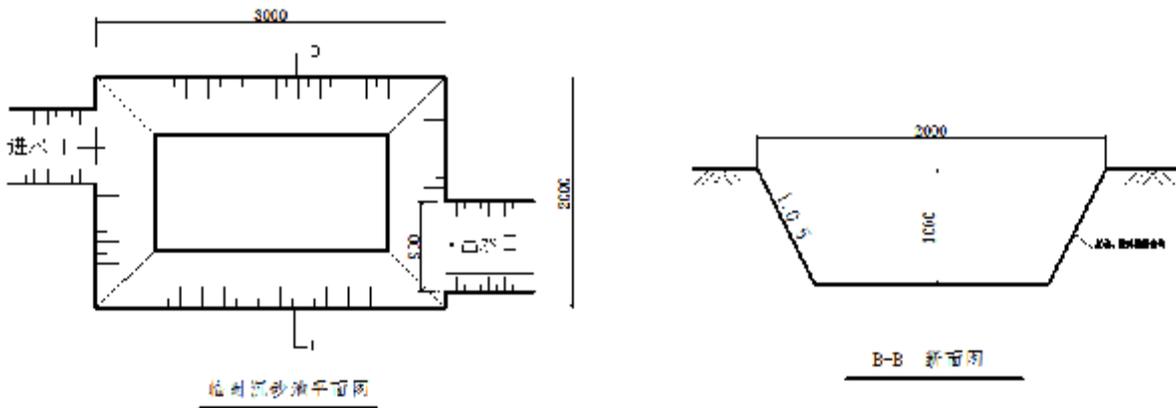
临时沉砂池典型设计断面图 单位：mm
